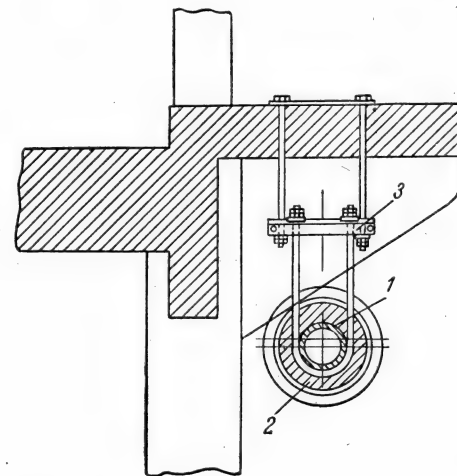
Подвеска газопровода влажного газа к железобетонному мосту:
